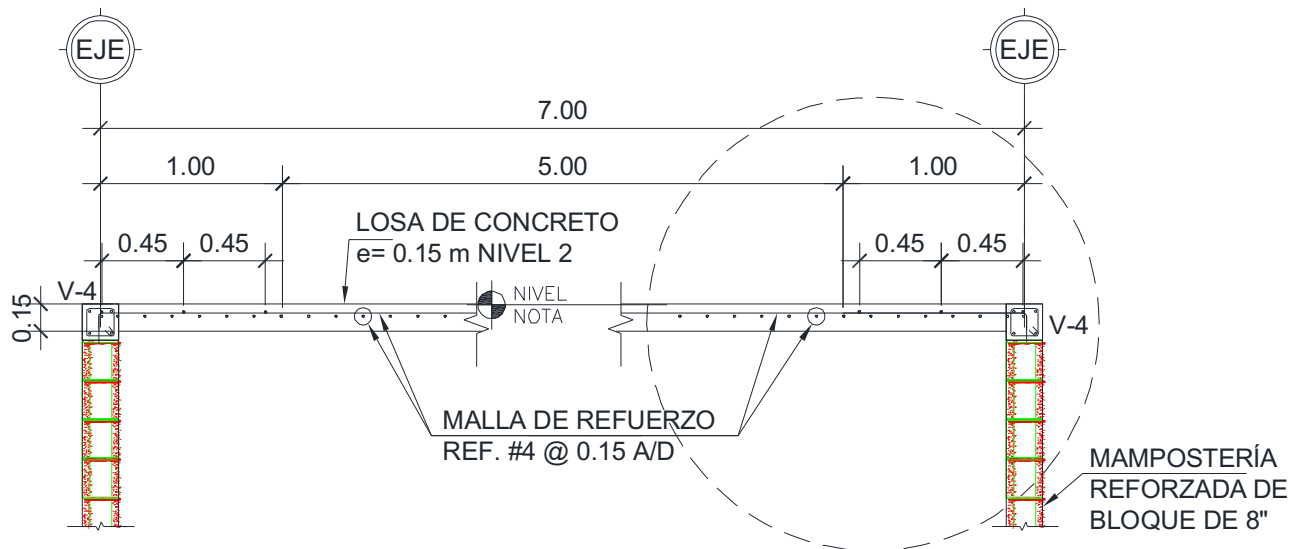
Sección transversal de Losa de techo en Dirección Transversal
